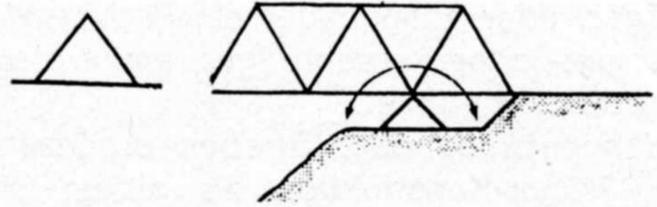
das feste Auflager: Zeichen und z. B. fest aufgelegter Fachwerkträger (Brücke).
